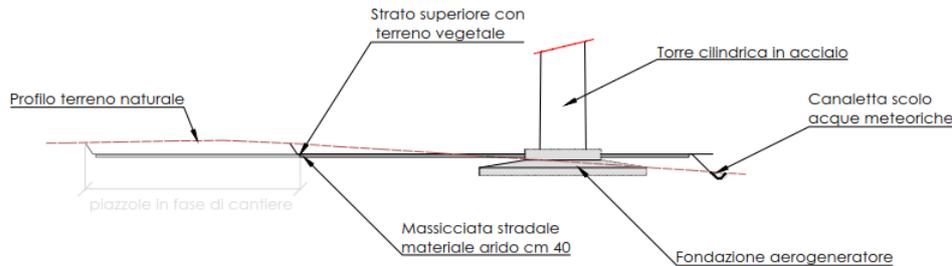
Planimetria tipologica ripristino aree piazzole
